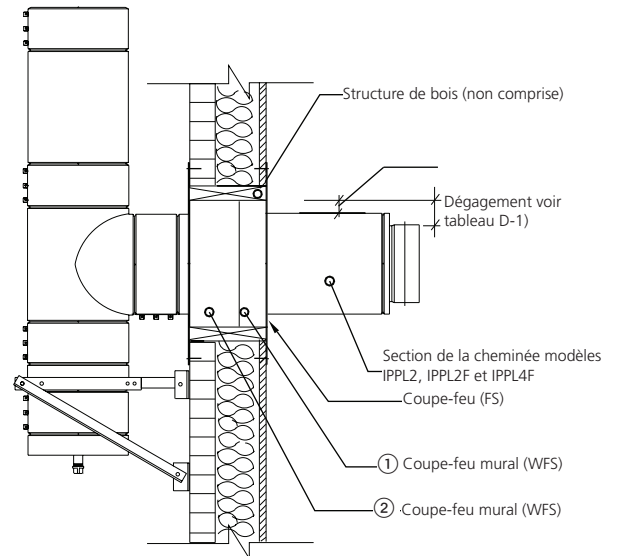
Assemblage du coupe-feu mural (WFS)
